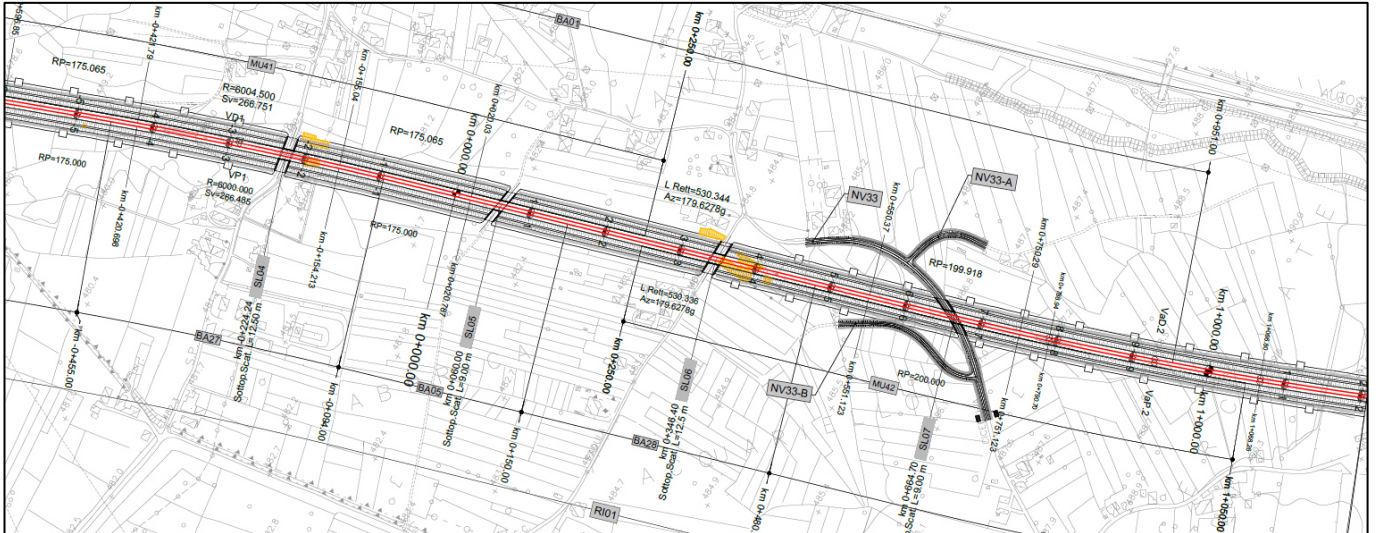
Planimetria con individuazione della nuova viabilità NV33
